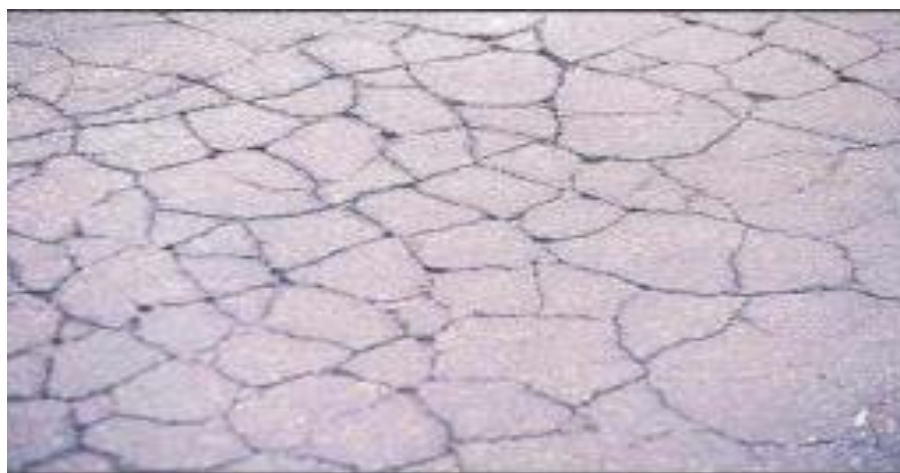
Grieta Tipo Piel de Cocodrilo
